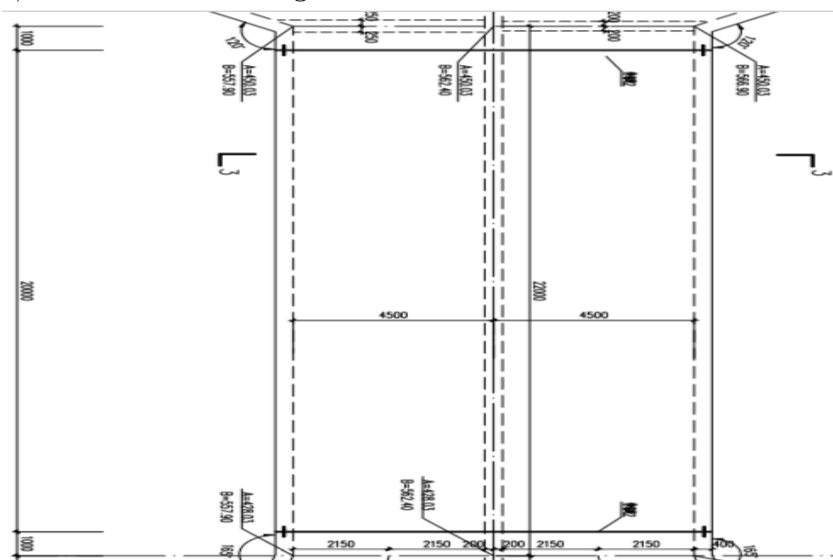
Planta do Troço-C da CCC do Soyo.
